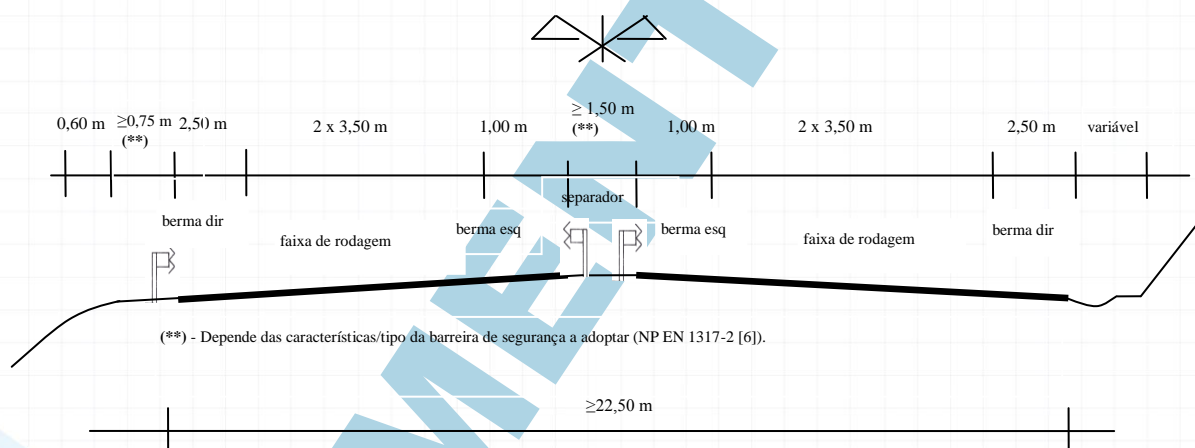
Perfil transversal tipo de auto-estrada suburbana.
